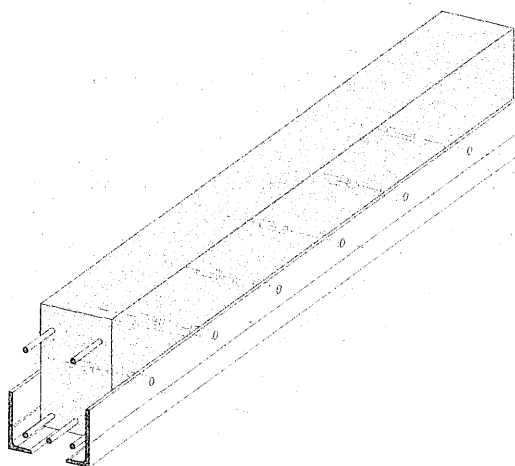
20. Refuerzo de vigas con angulares y anclajes.
